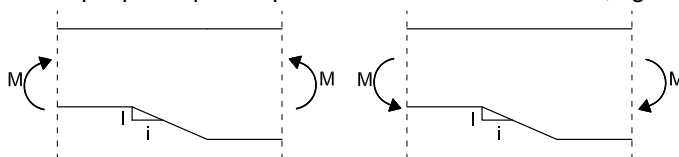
Flexió a la zona rebaixada. Esquerra: tensions de tracció al rebaix; dreta: tensions de compressió al rebaix
